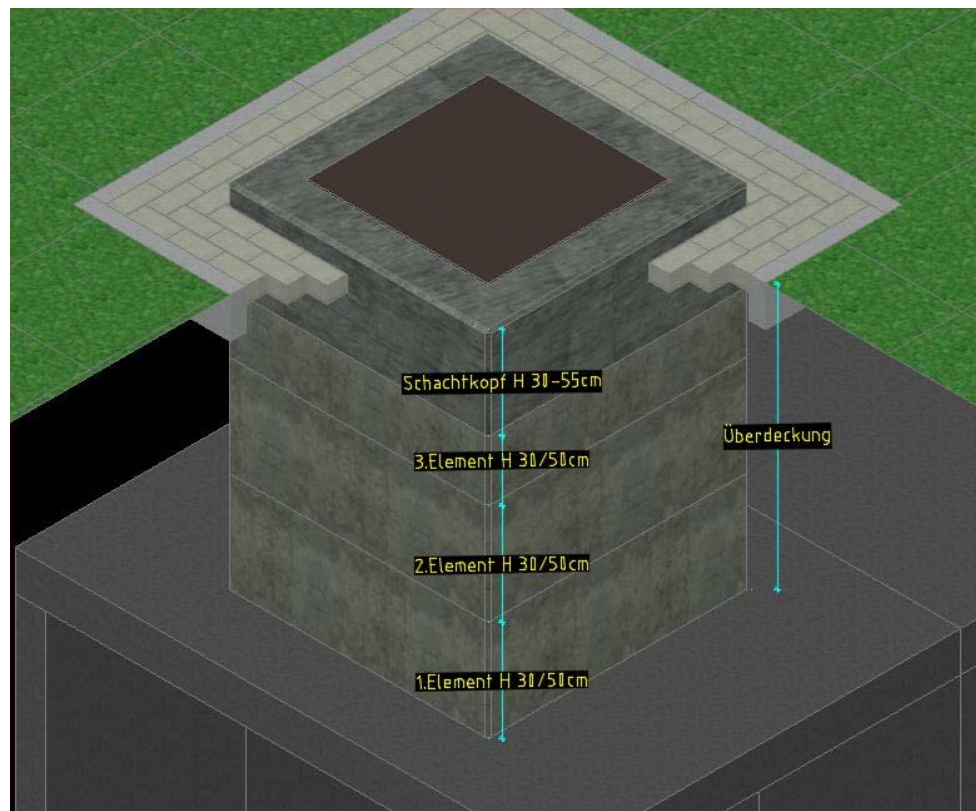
Darstellung eines Schachthalses mit Systemelementen
